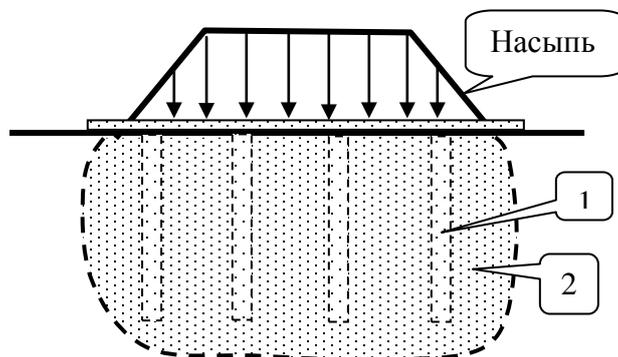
Глубинное уплотнение грунта основания пригрузкой:
